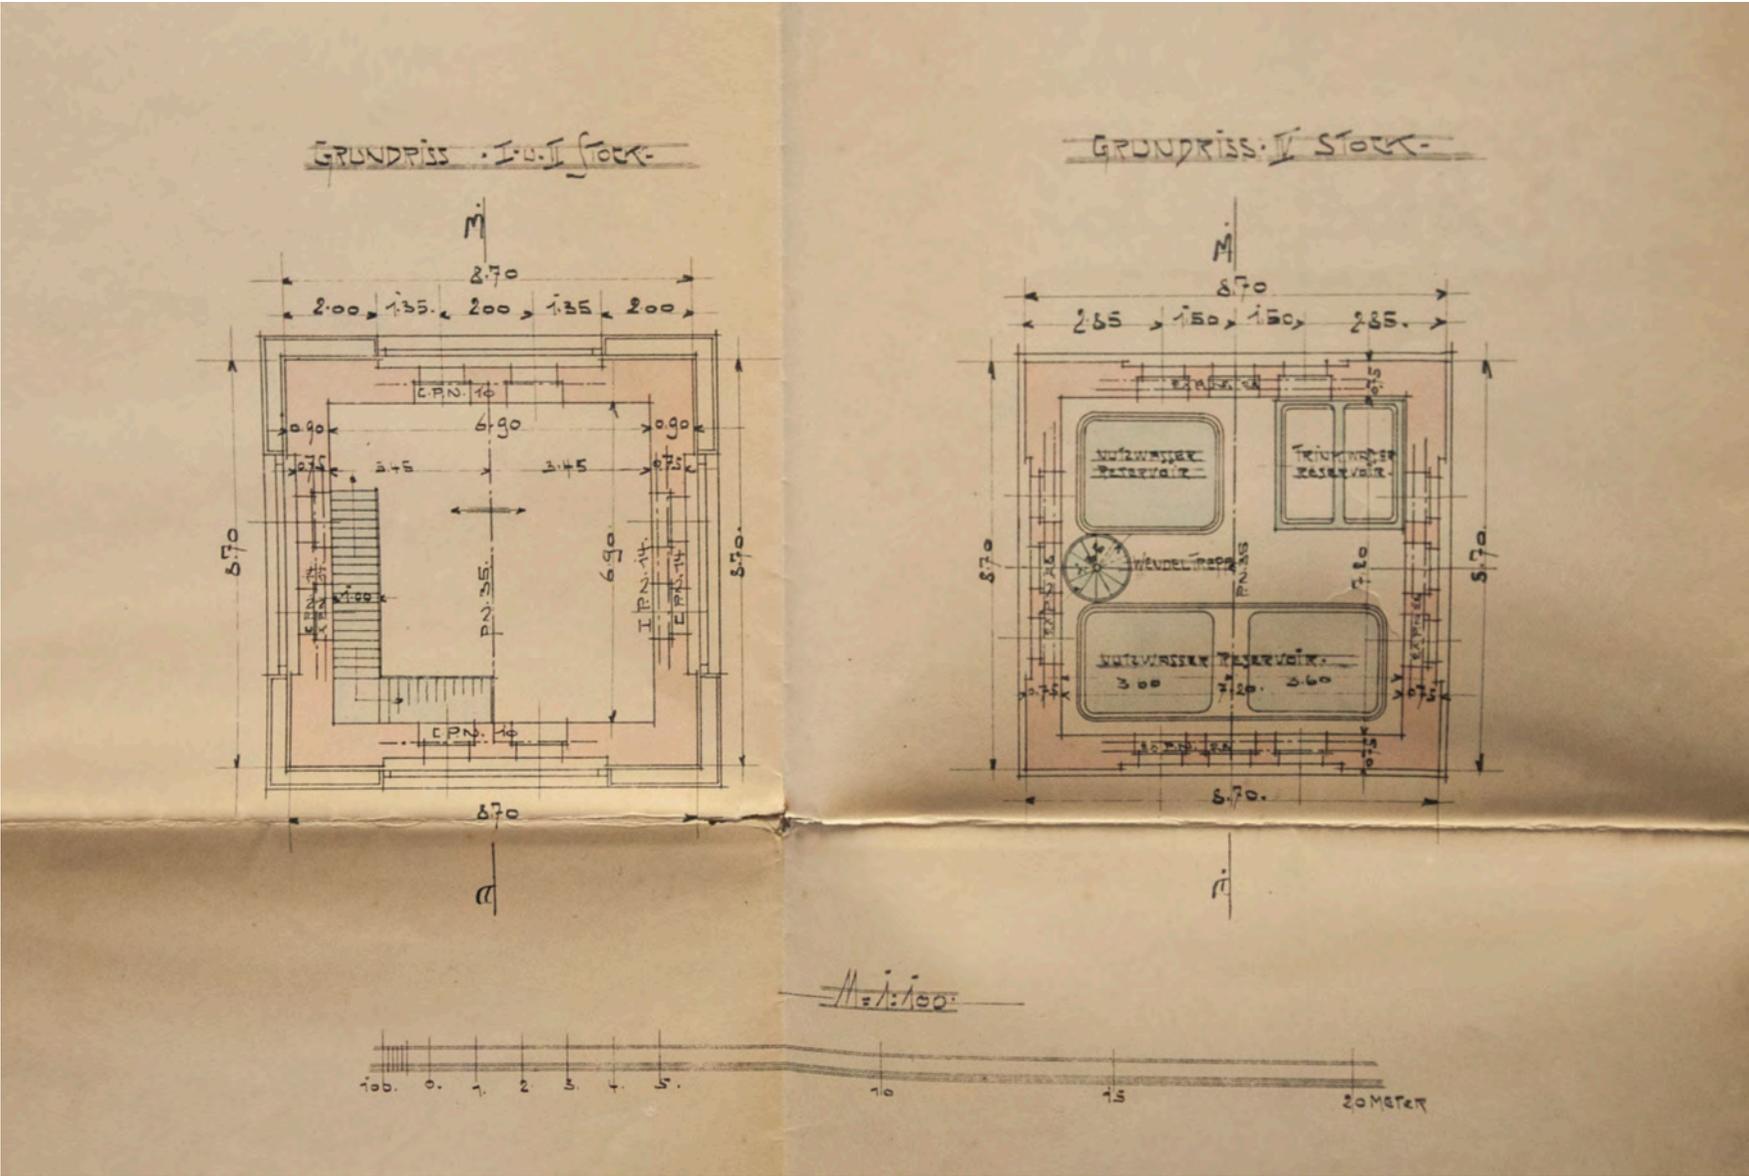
Grundrisse des ersten, zweiten und vierten Geschoßes des Wasserturms (W)
